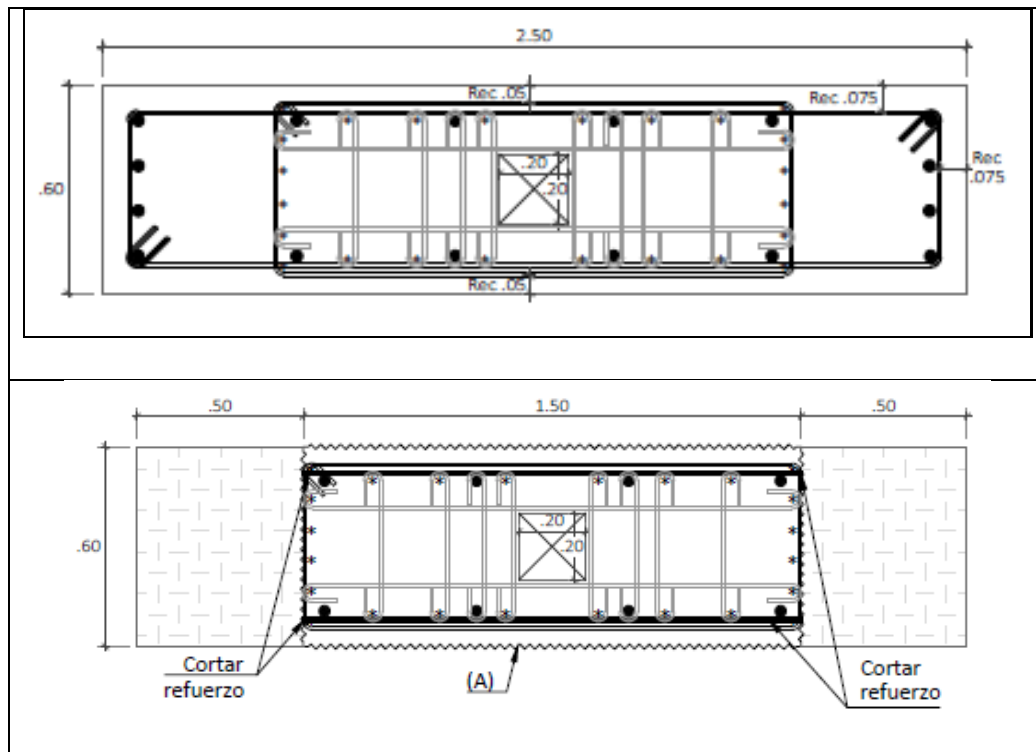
Detalle de Refuerzo vertical del elemento Barrete BC - 84 - C1.
